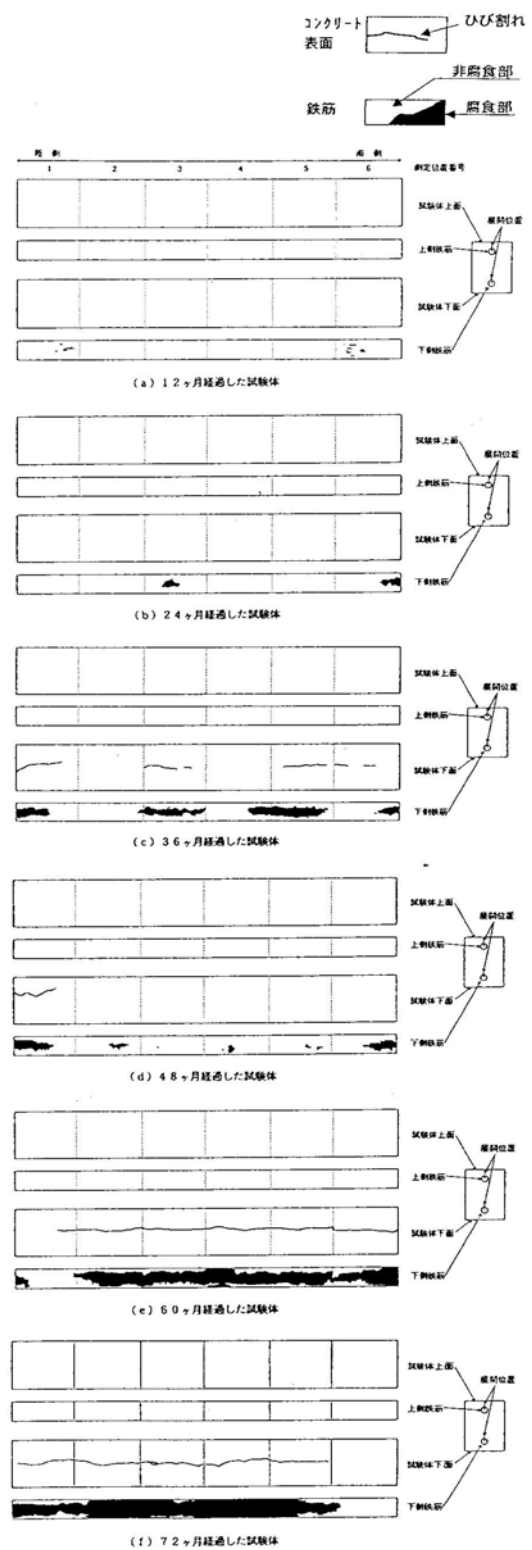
沖縄材料試験体のひび割れと腐食状況
